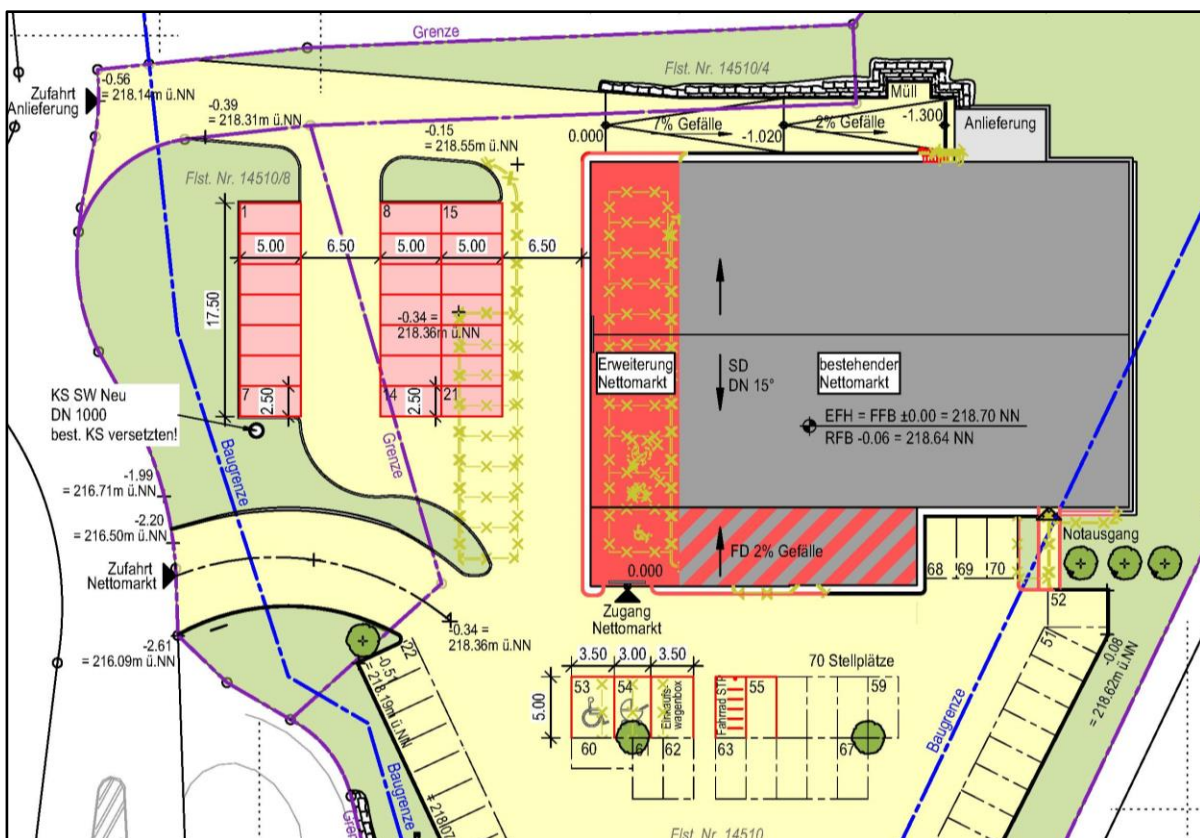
Lageplan mit Darstellung der Markterweiterung – Quelle: Hollerbach Bauplanungsgesellschaft
